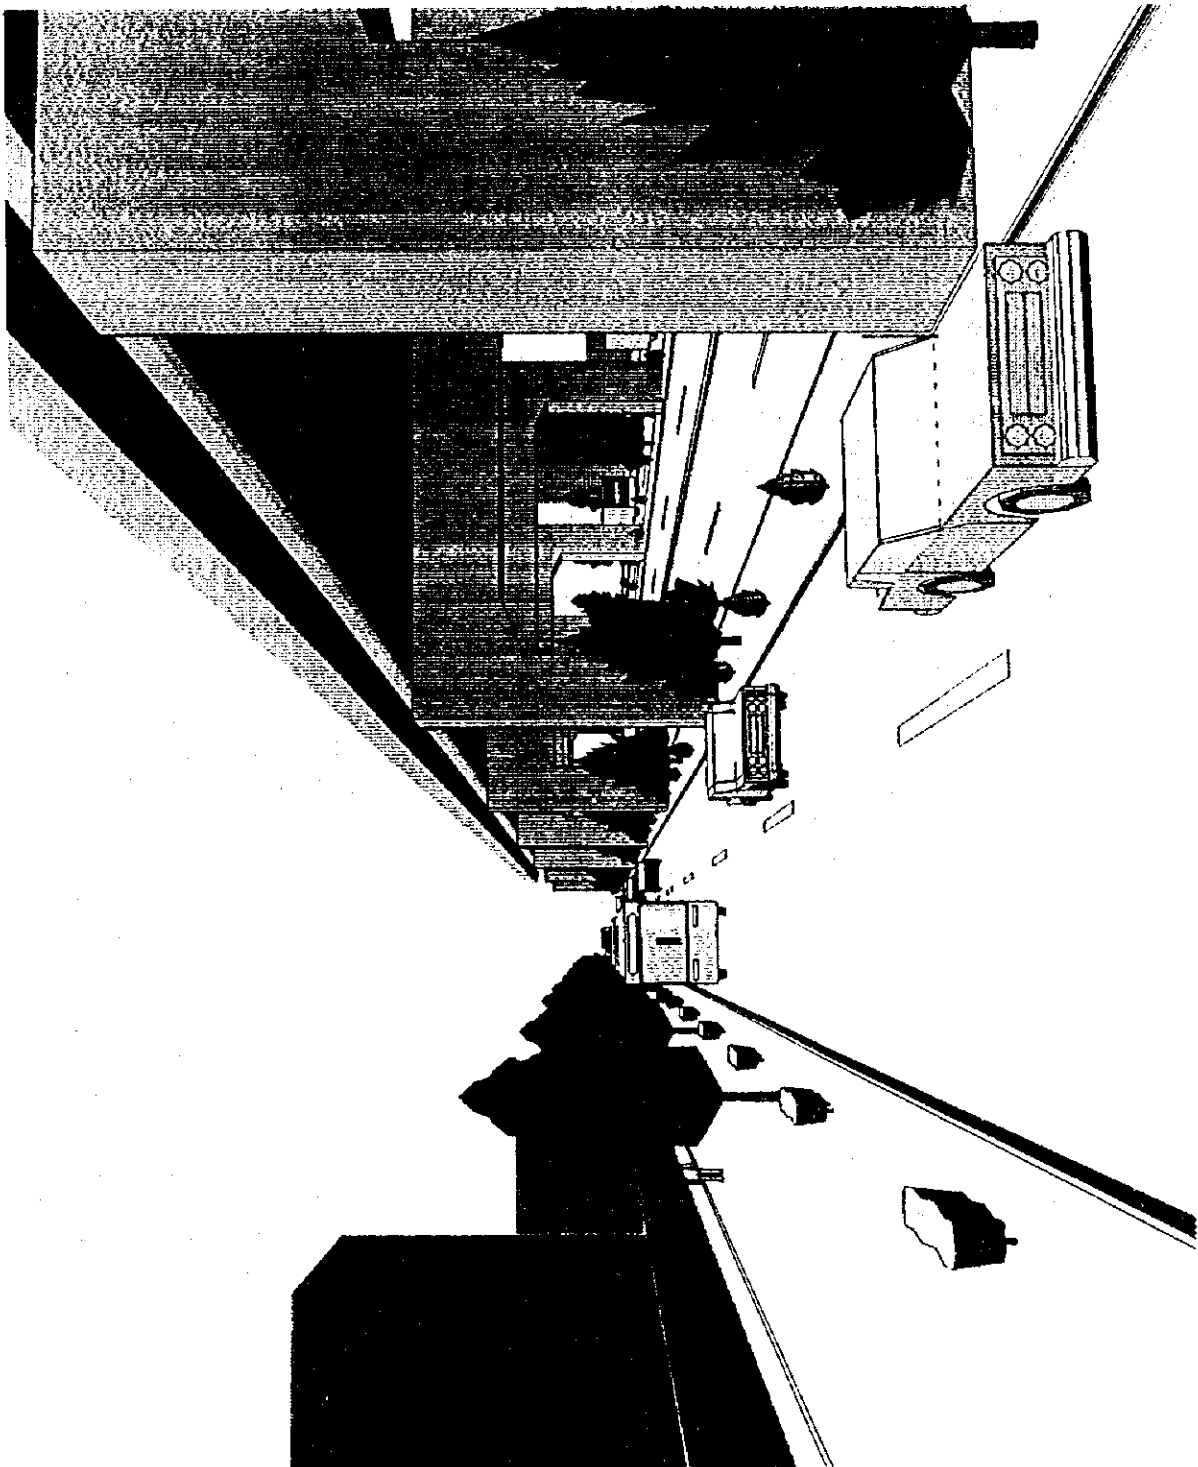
Plano tridimensional de la Alternativa -A en la Avenida 7a
